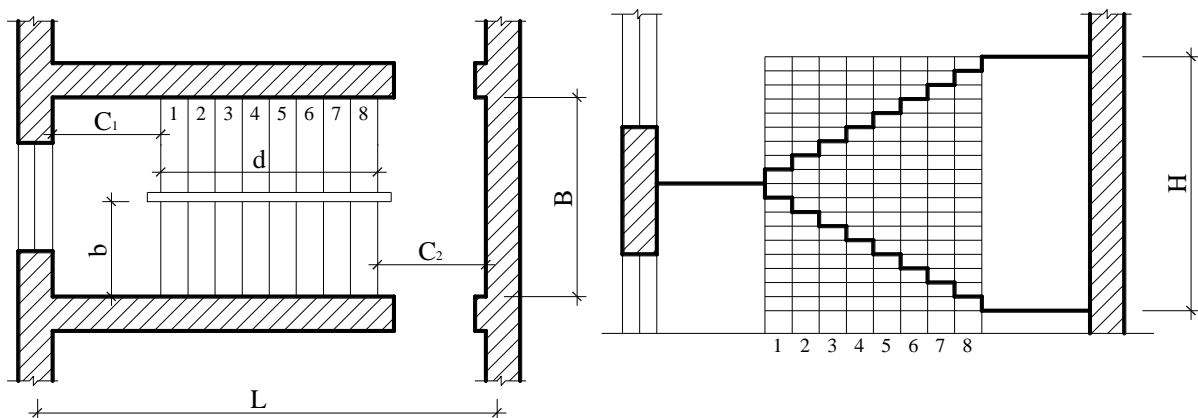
Побудова двомаршевої сходової клітки житлового будинку
